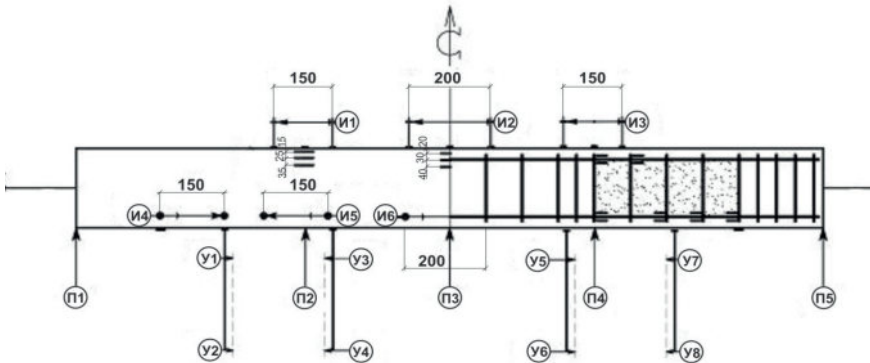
Схема армирования, расстановки приборов и испытания опытной балки
